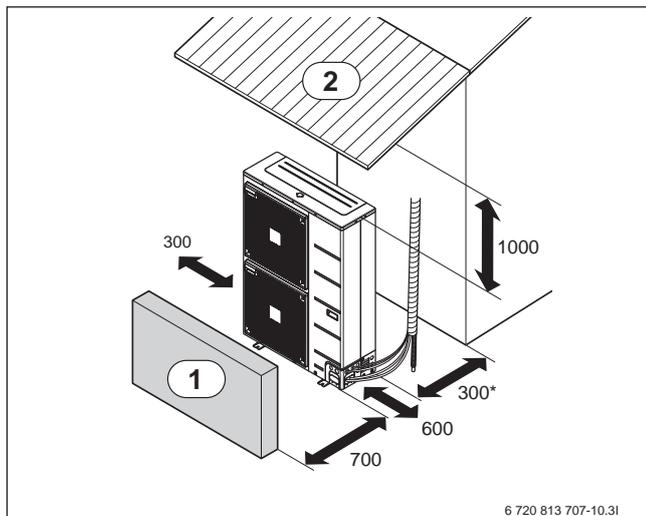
Mindestabstand Wärmepumpe – Umgebung (mm)
